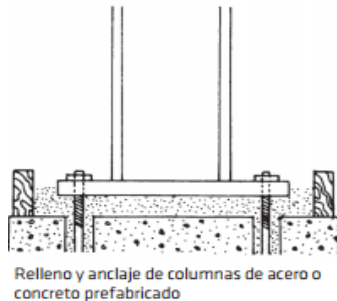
Grout fundido bajo placa base de columna metálica (Fuente: <https://col.sika.com/>).
